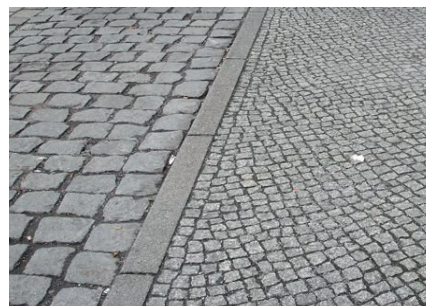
Vorzone Gebäude Naturstein Kleinpflästerung 7/9, Abschlussstein und Passée Pflästerung, behindertengerecht gem. ProCap
